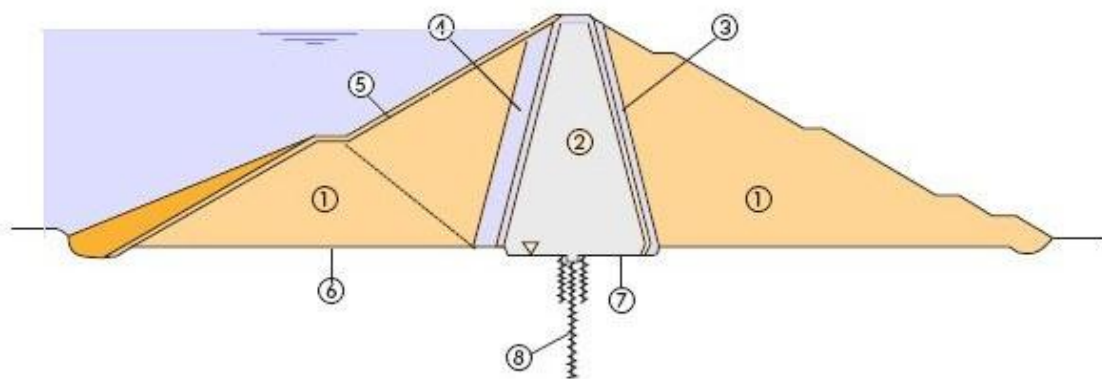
Coupe transversale d'un barrage en enrochement[9]
